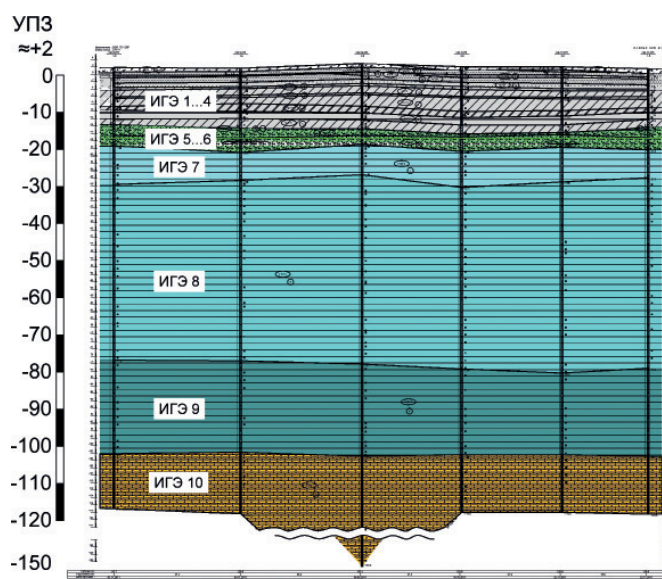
Схема расположения слоёв грунта на площадке строительства
